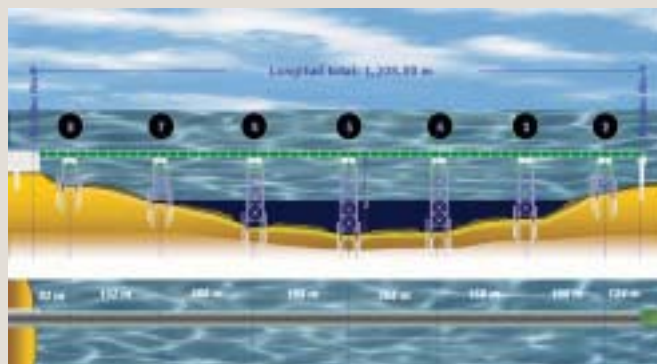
Croquis del puente Chiapas: a) vista en elevación; b) vista en planta.
